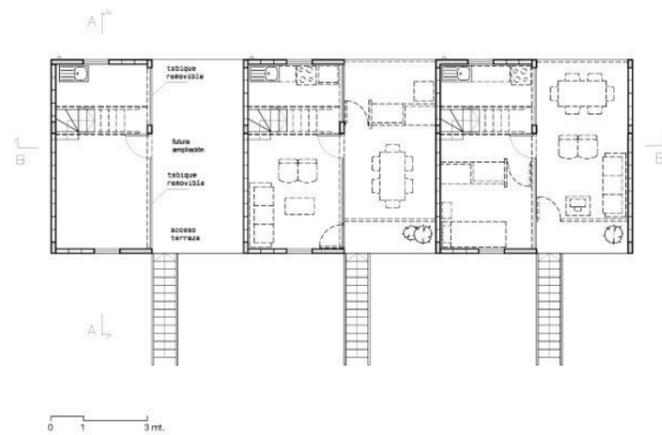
Propuesta final planta primera – www.elementalchile.cl
